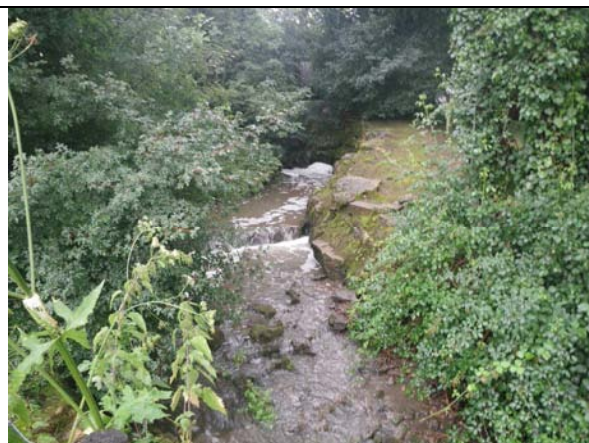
Ouvrage (chute env.2m) aménagé par une succession de seuils de faibles hauteurs de chute (FIL4)
